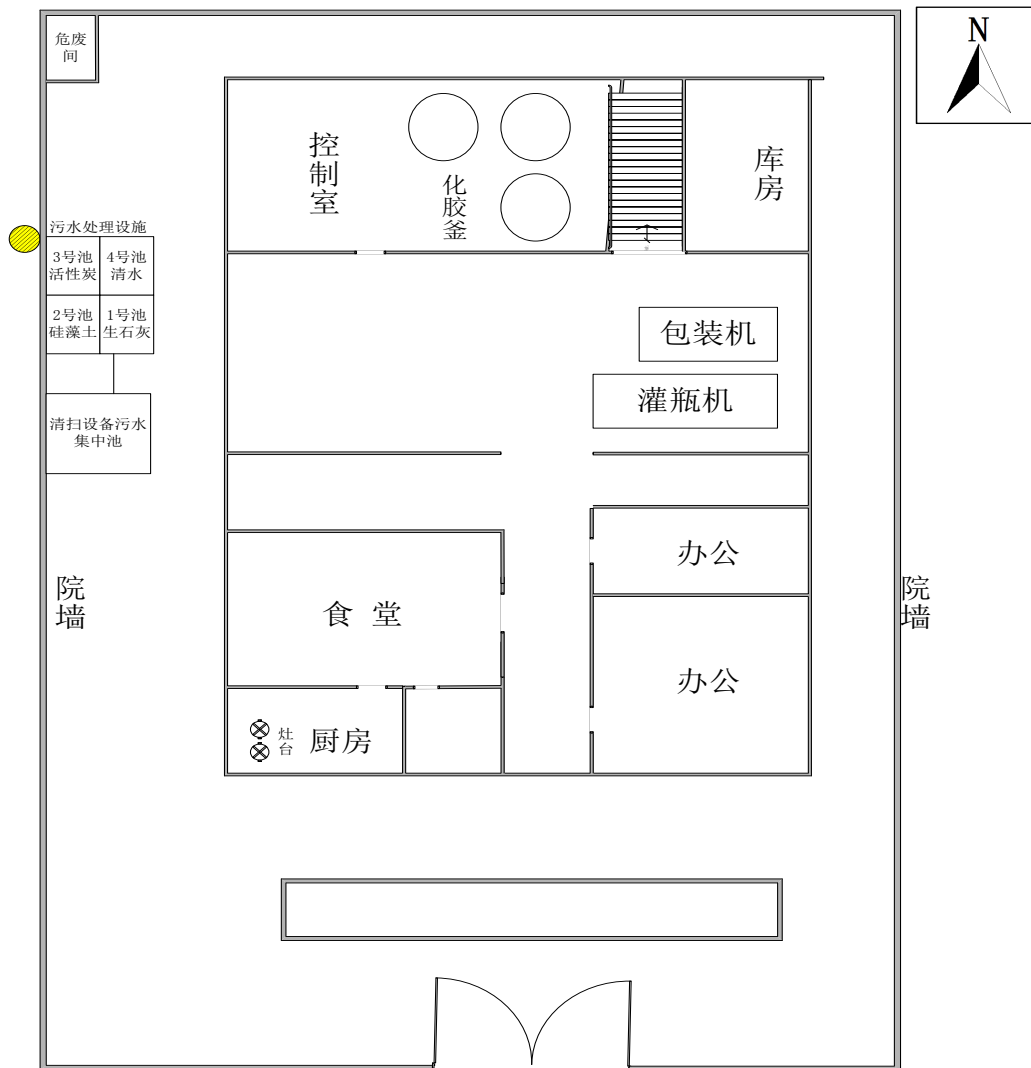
项目平面布置图（地上 1 层平面布置图）
